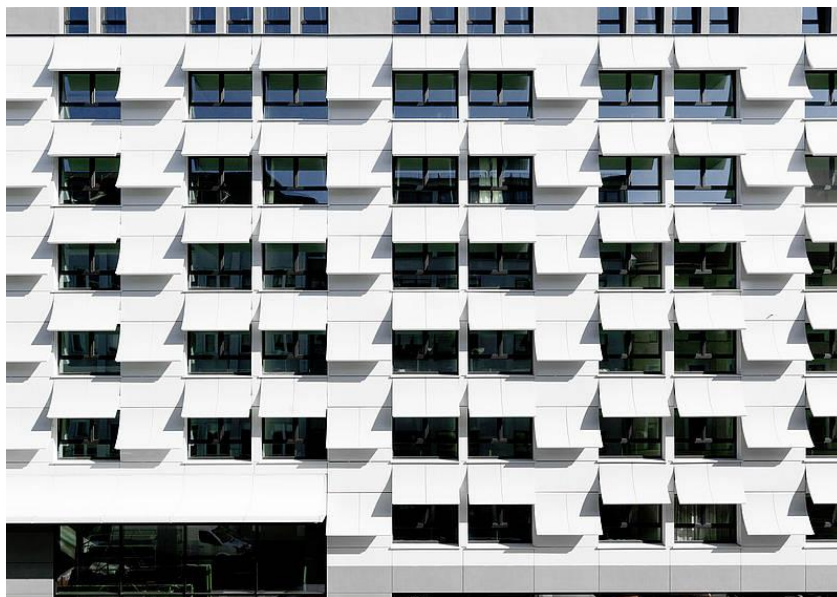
Exemplo de fachada de um edifício em GRC (Rider)
